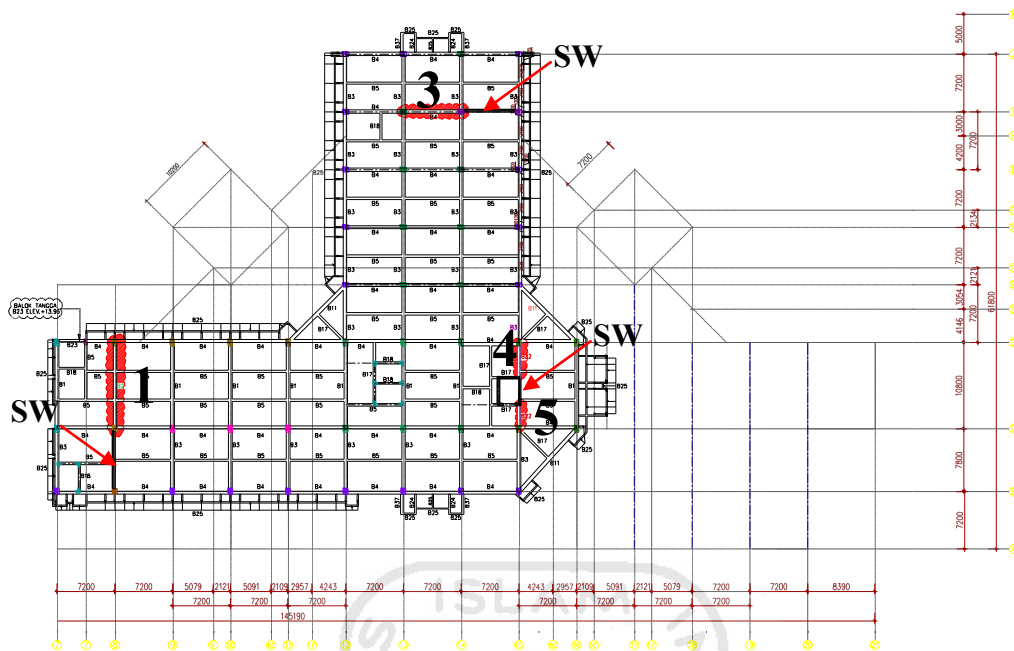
31 Balok yang berpotensi menjadi elemen kolektor pada lantai 4
